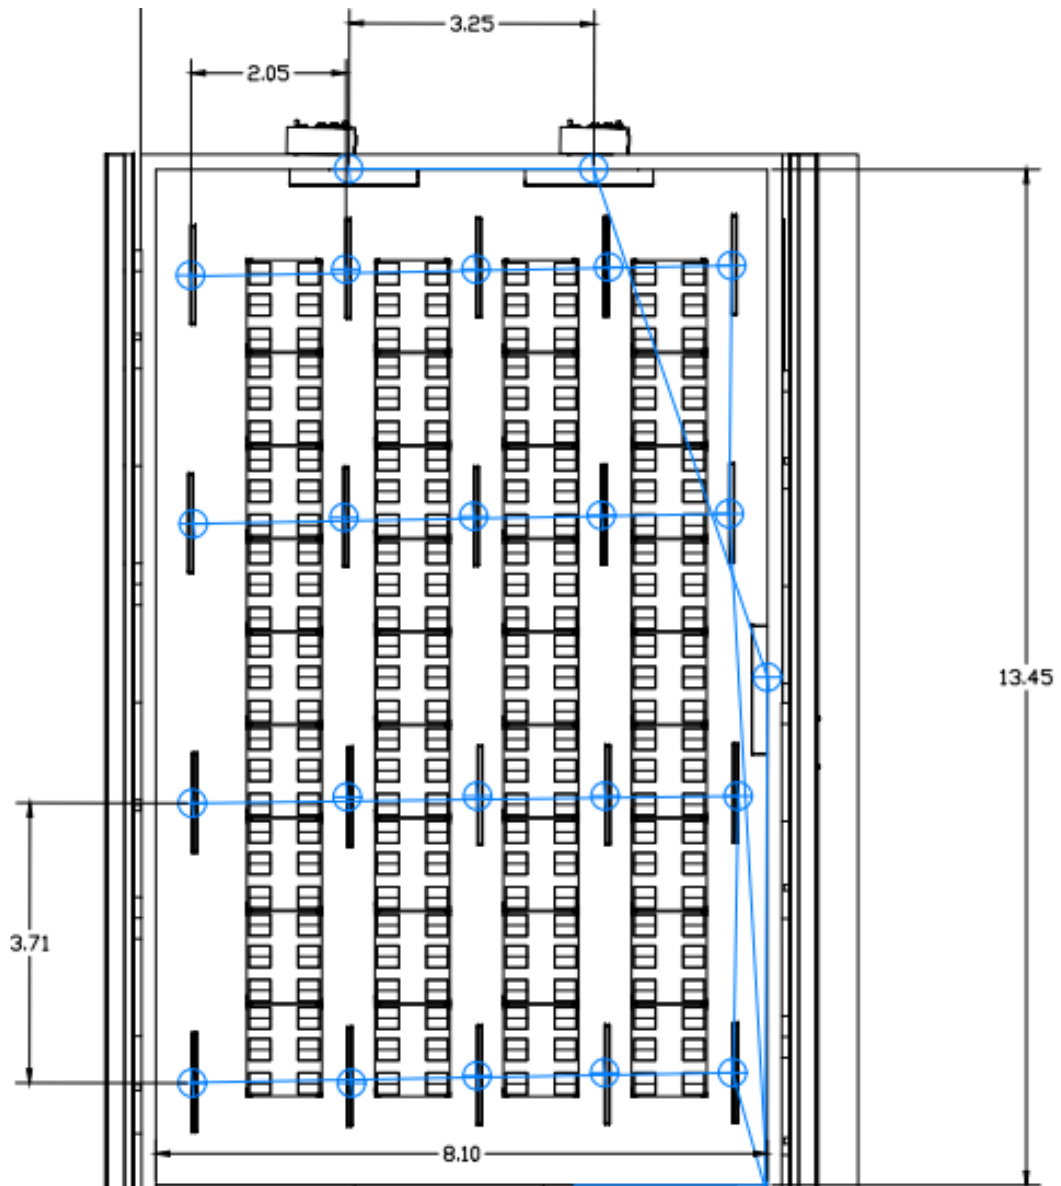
Plano arquitectónico en planta con trazado eléctrico de la zona de archivos.
